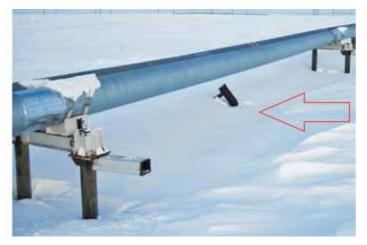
Выдёргивание фундамента и полное изъятие свай из грунтов основания вследствие действия касательных сил морозного пучения
